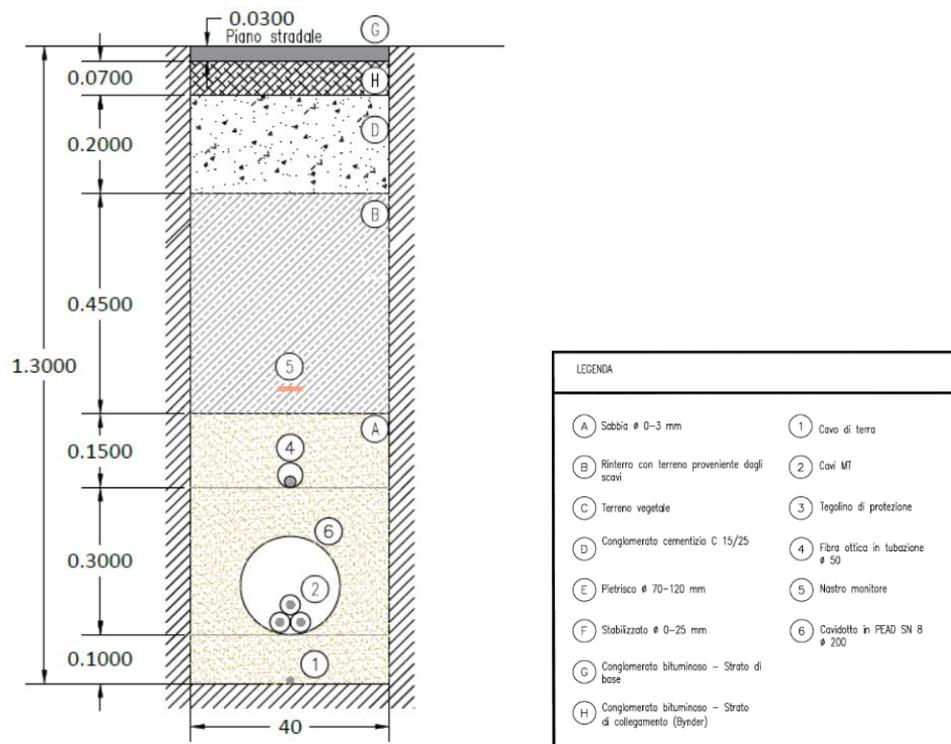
Sezione tipo del cavidotto di progetto su viabilità
